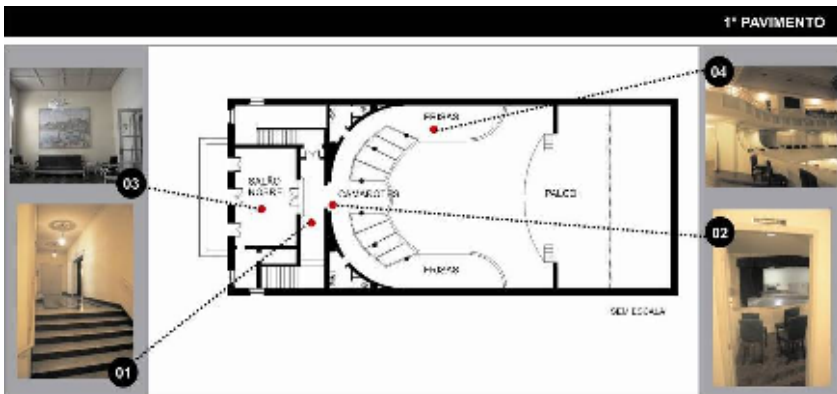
Primeiro pavimento do TAC – camarotes e frisas. Fonte: Autora (2009).
